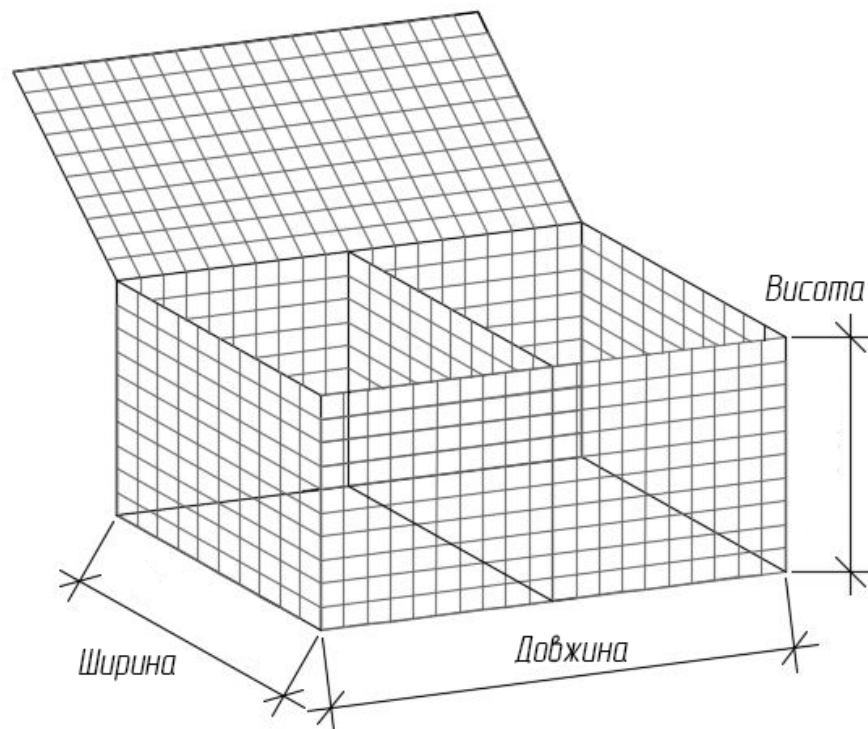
Коробчастий тип габіону з зварною сіткою
